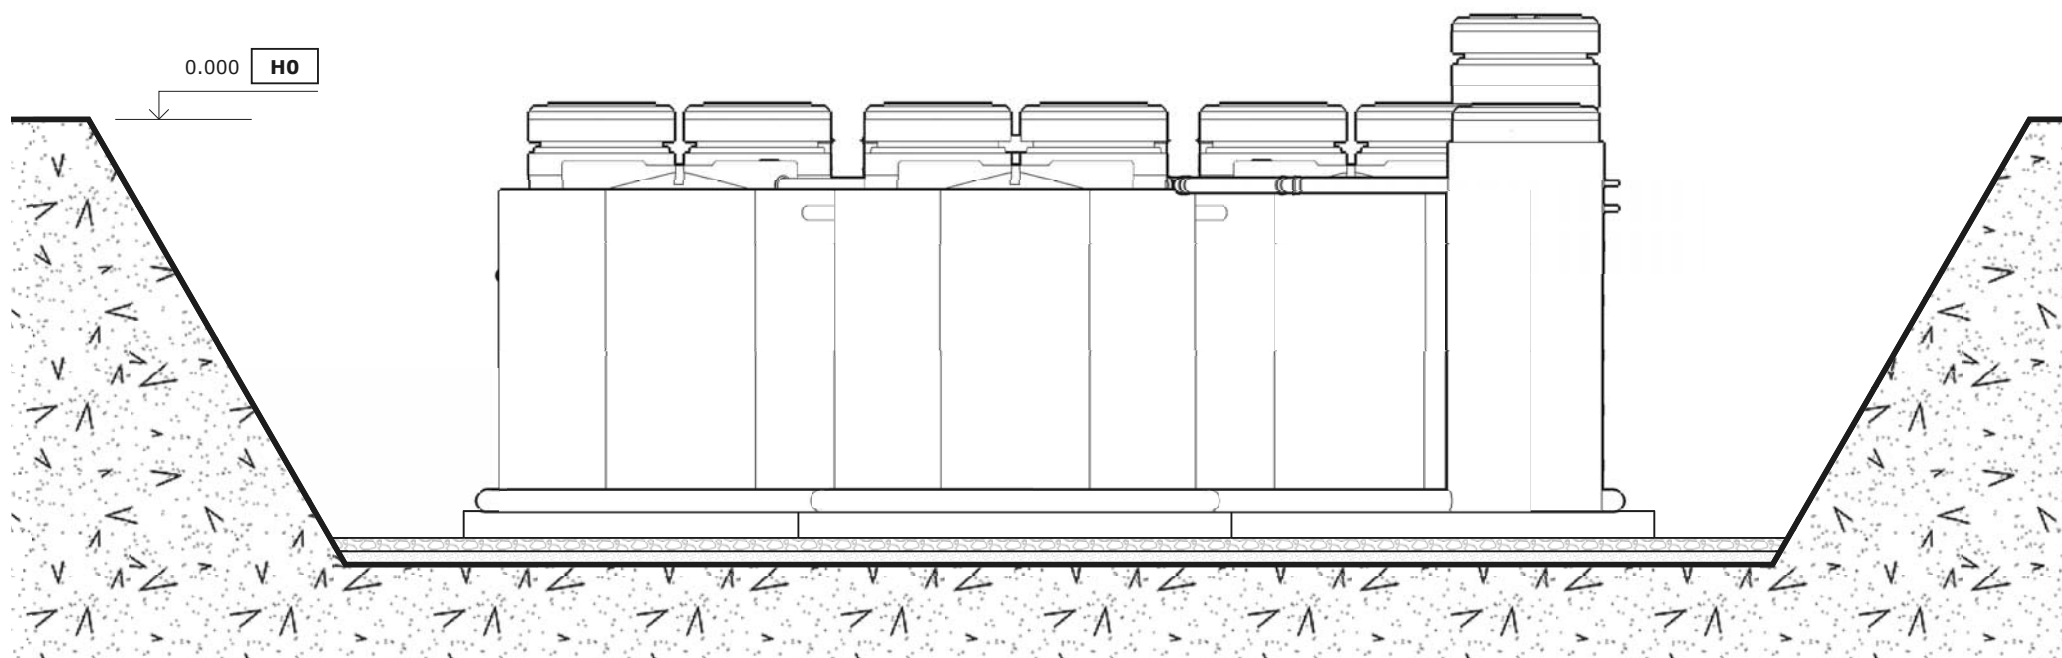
Засыпка песка, монтаж отводящего трубопровода.
